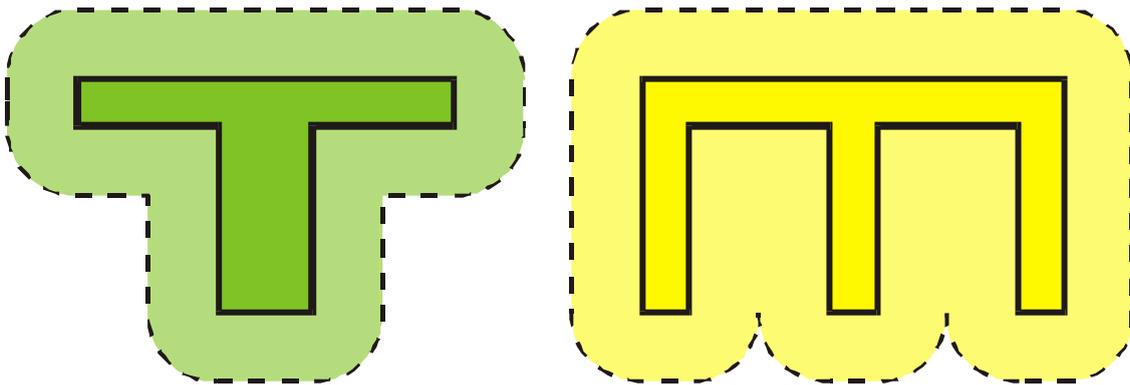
Zwei grundsätzliche Gebäudetypen mit skizzierten äquivalenten Fangflächen.
